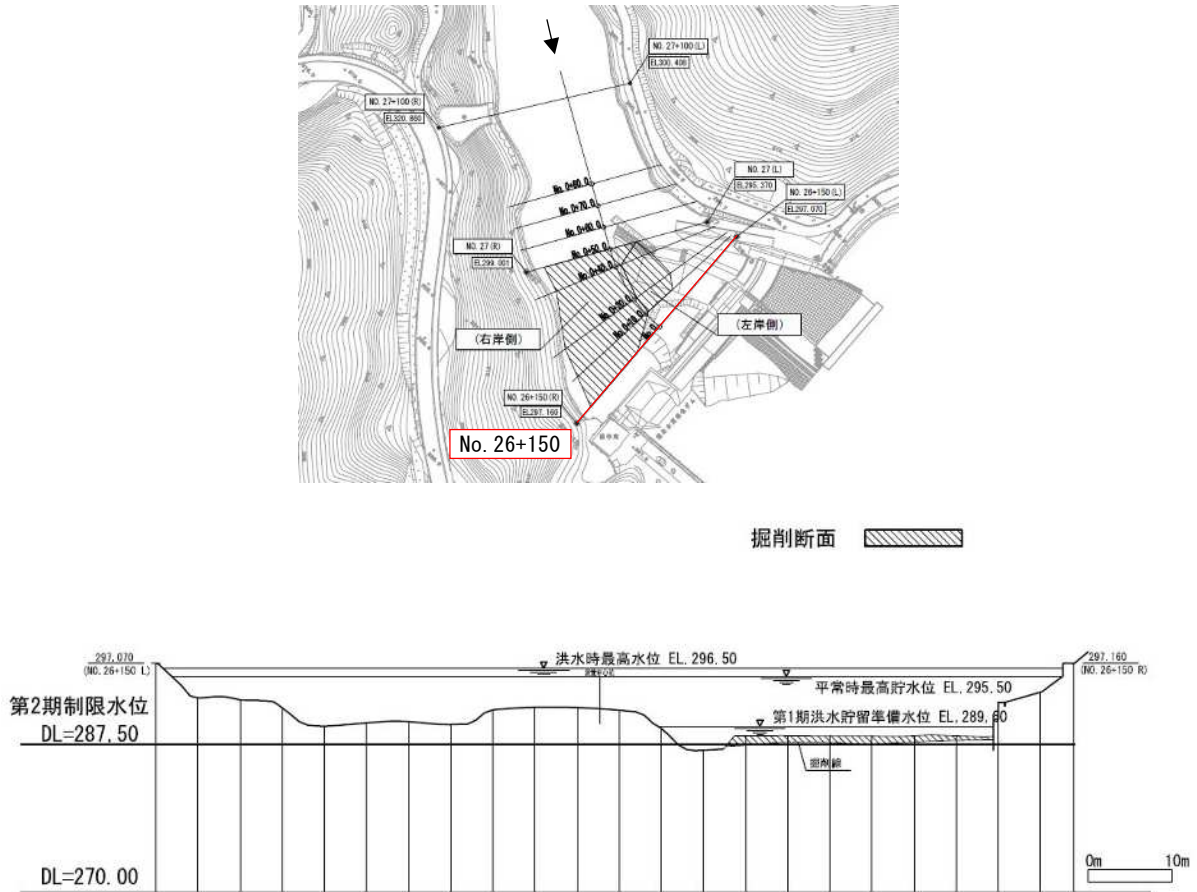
水質保全ダムの掘削形状 【参考：H30】 上：平面図、下 断面図(No. 26+150)
